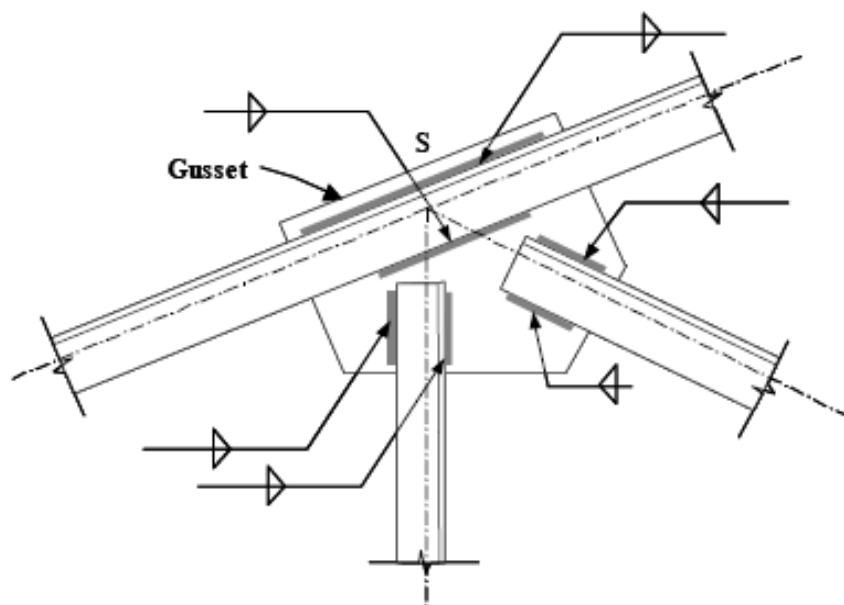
تعيين أماكن اللحام بواسطة خط السهم Specifying Weld Locations
